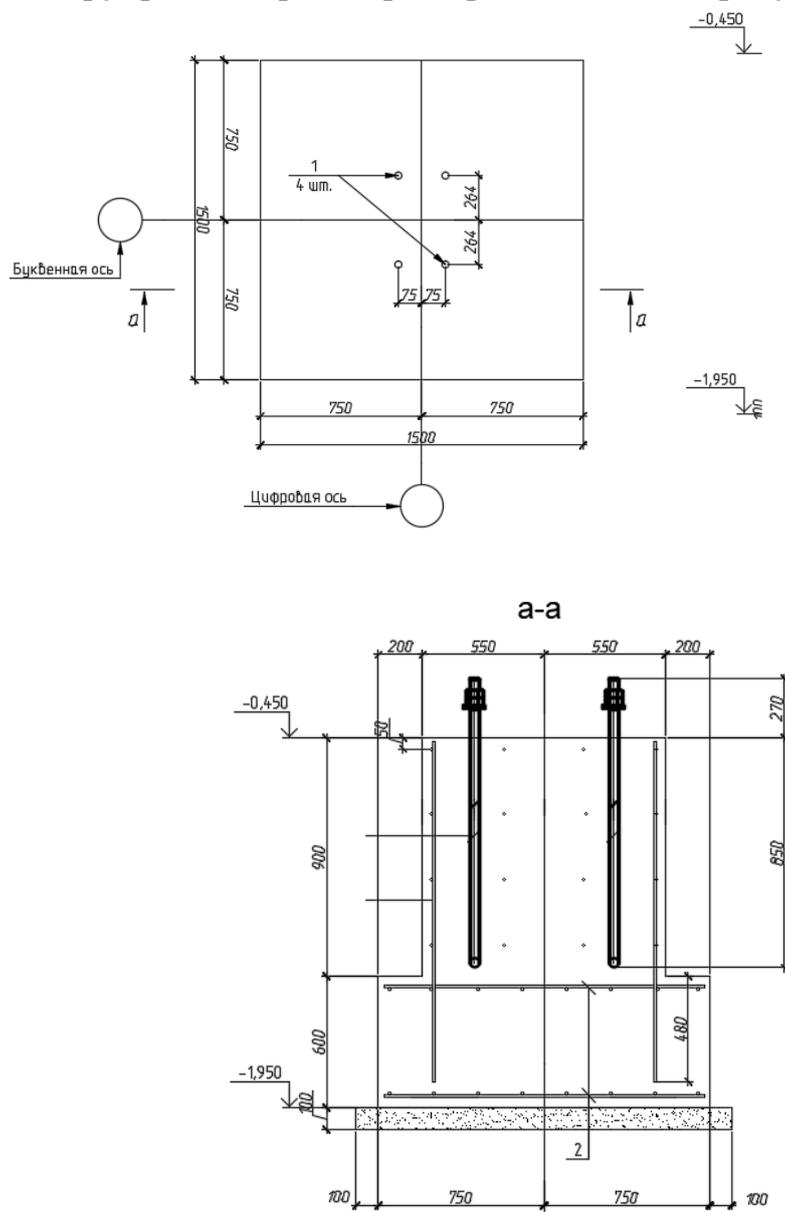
Столбчатый фундамент под колонну К1
